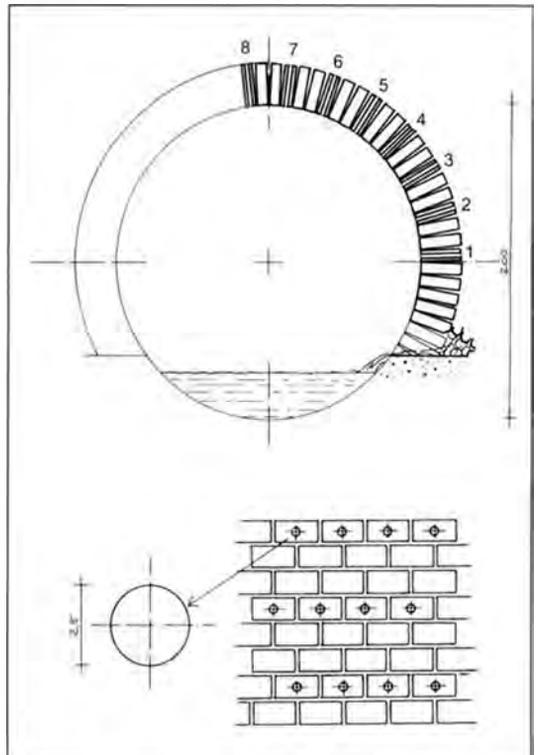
Sezione trasversale tipo della galleria e disposizione dei fori drenanti (grafica W. Fornella).
